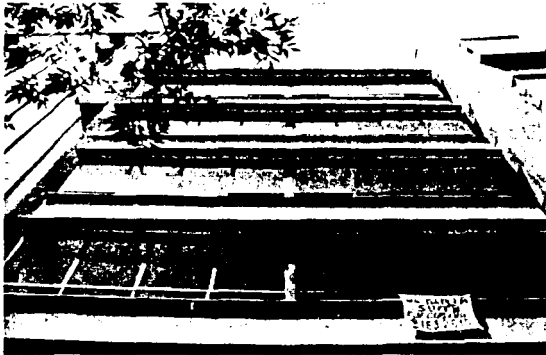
ESTRUCTURA PRINCIPAL DEL EDIFICIO AV. RÍO MIXCOAC No. 37
